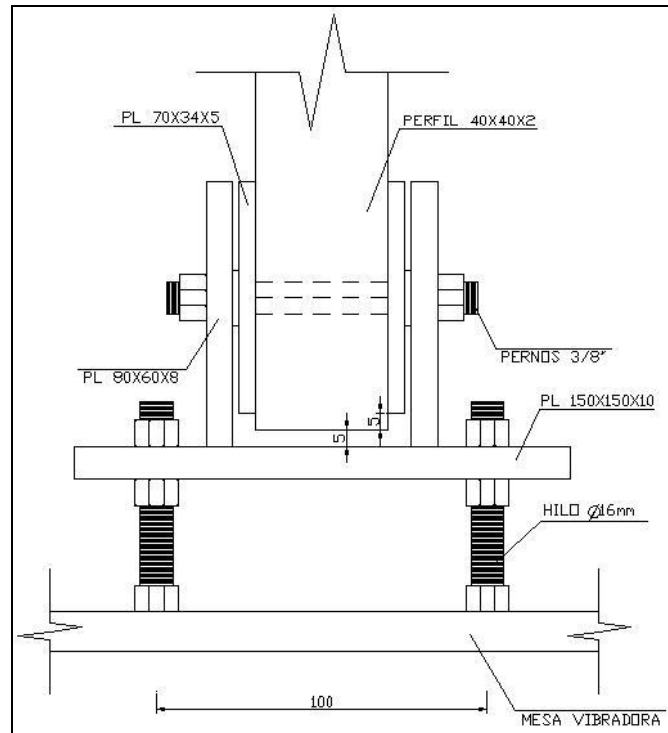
Detalle del Apoyo. Vista Lateral.
